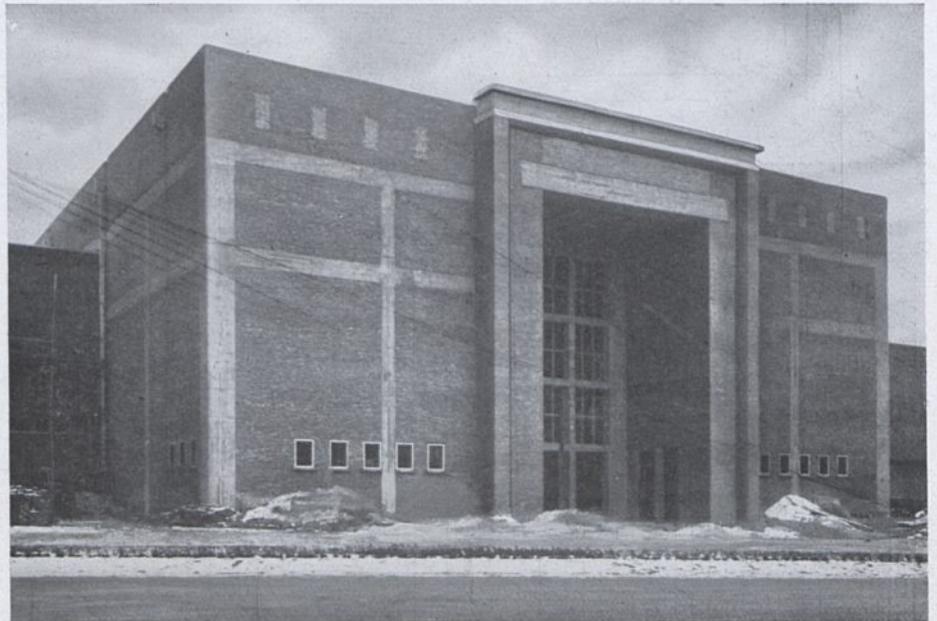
Ansicht des Nordgiebels der Halle 20 (Rohbau).
